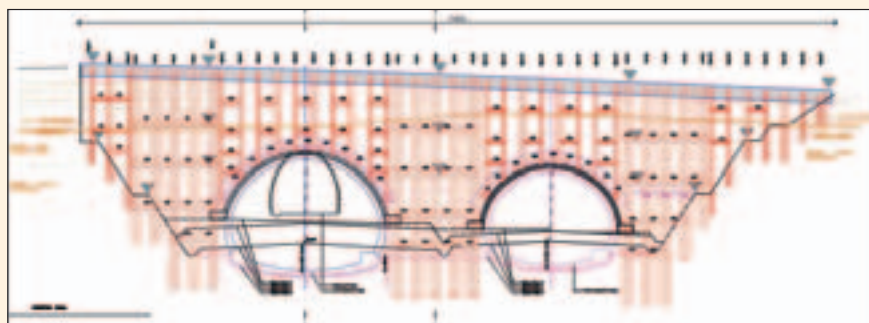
Vzorový příčný řez konstrukcí portálové stěny
